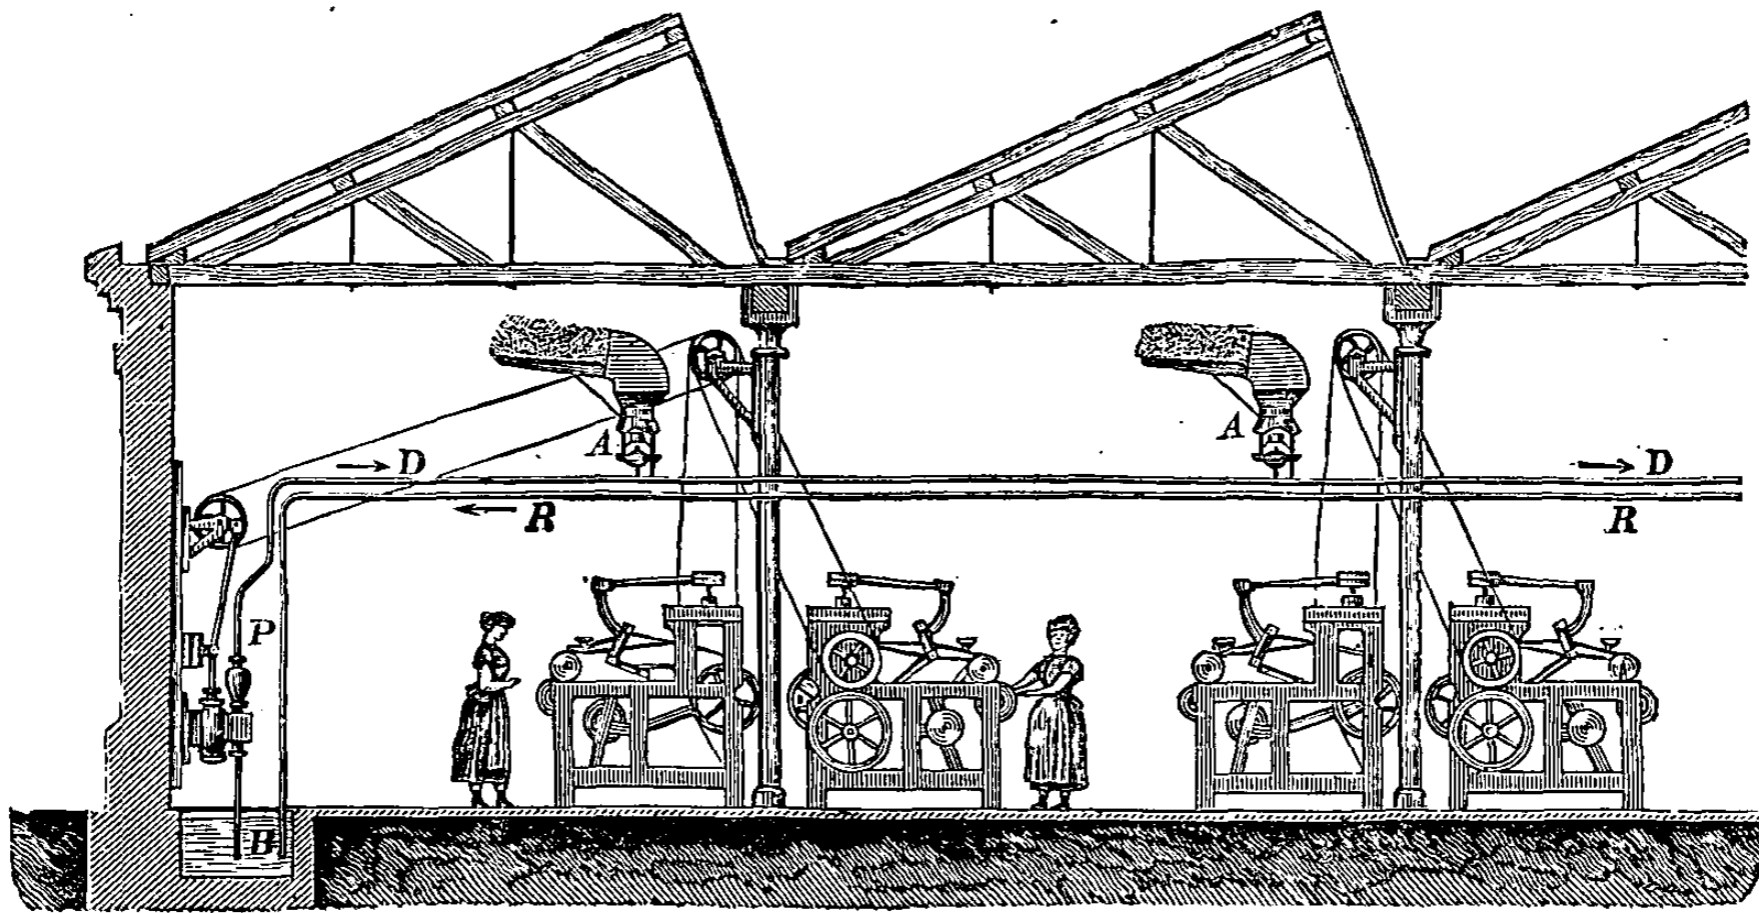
Coupe d'une usine avec installation d'appareils Kœrting.
